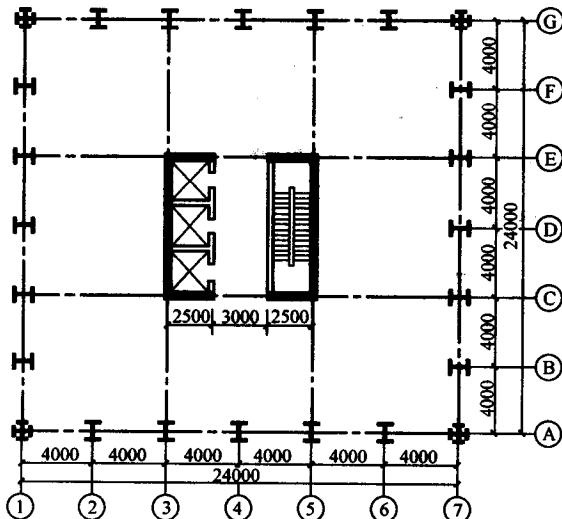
钢框架-钢筋混凝土核心筒高层混合结构平面示意图
